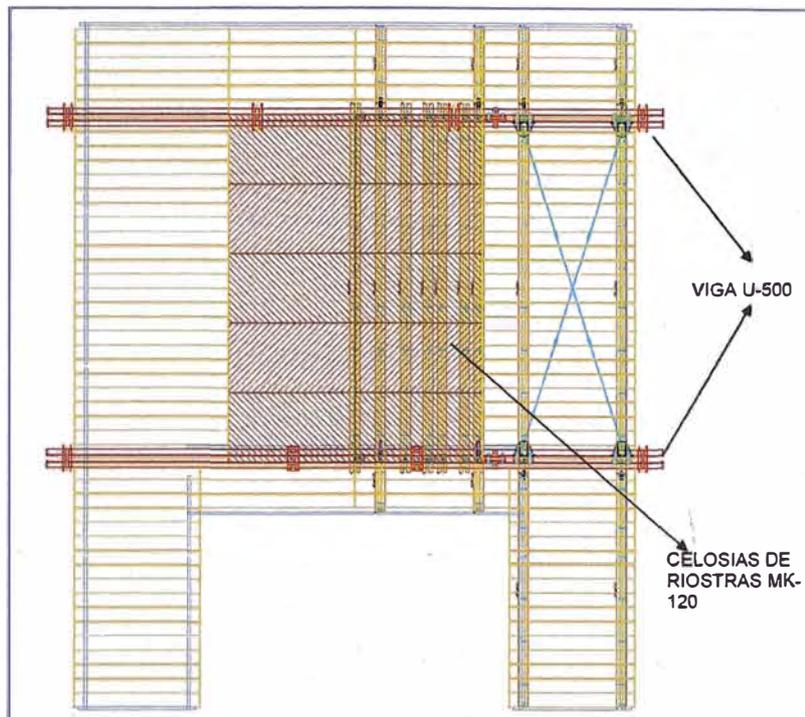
Vista planta encofrado de fondo - Fuente: Elaboración Propia
